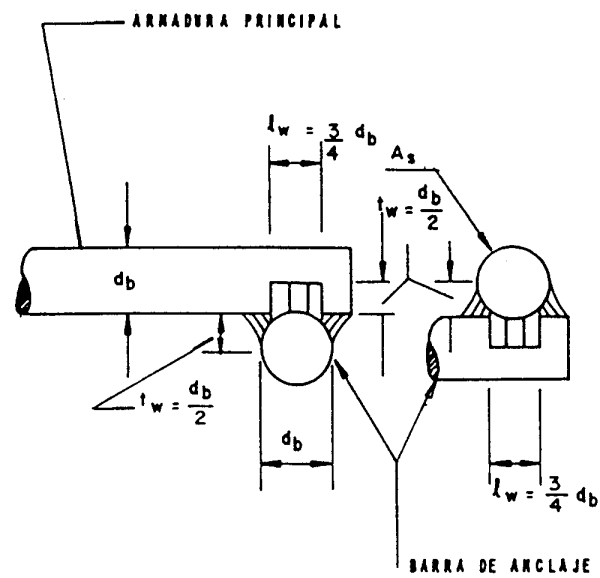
DETALLE DE LA SOLDADURA
